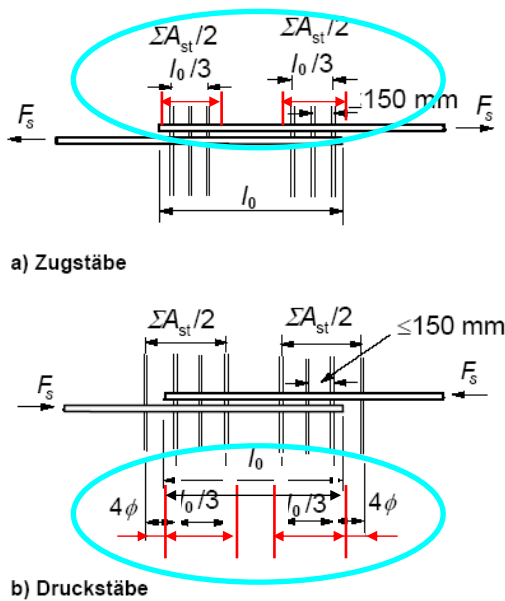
Querbewehrung für Übergreifungsstöße
